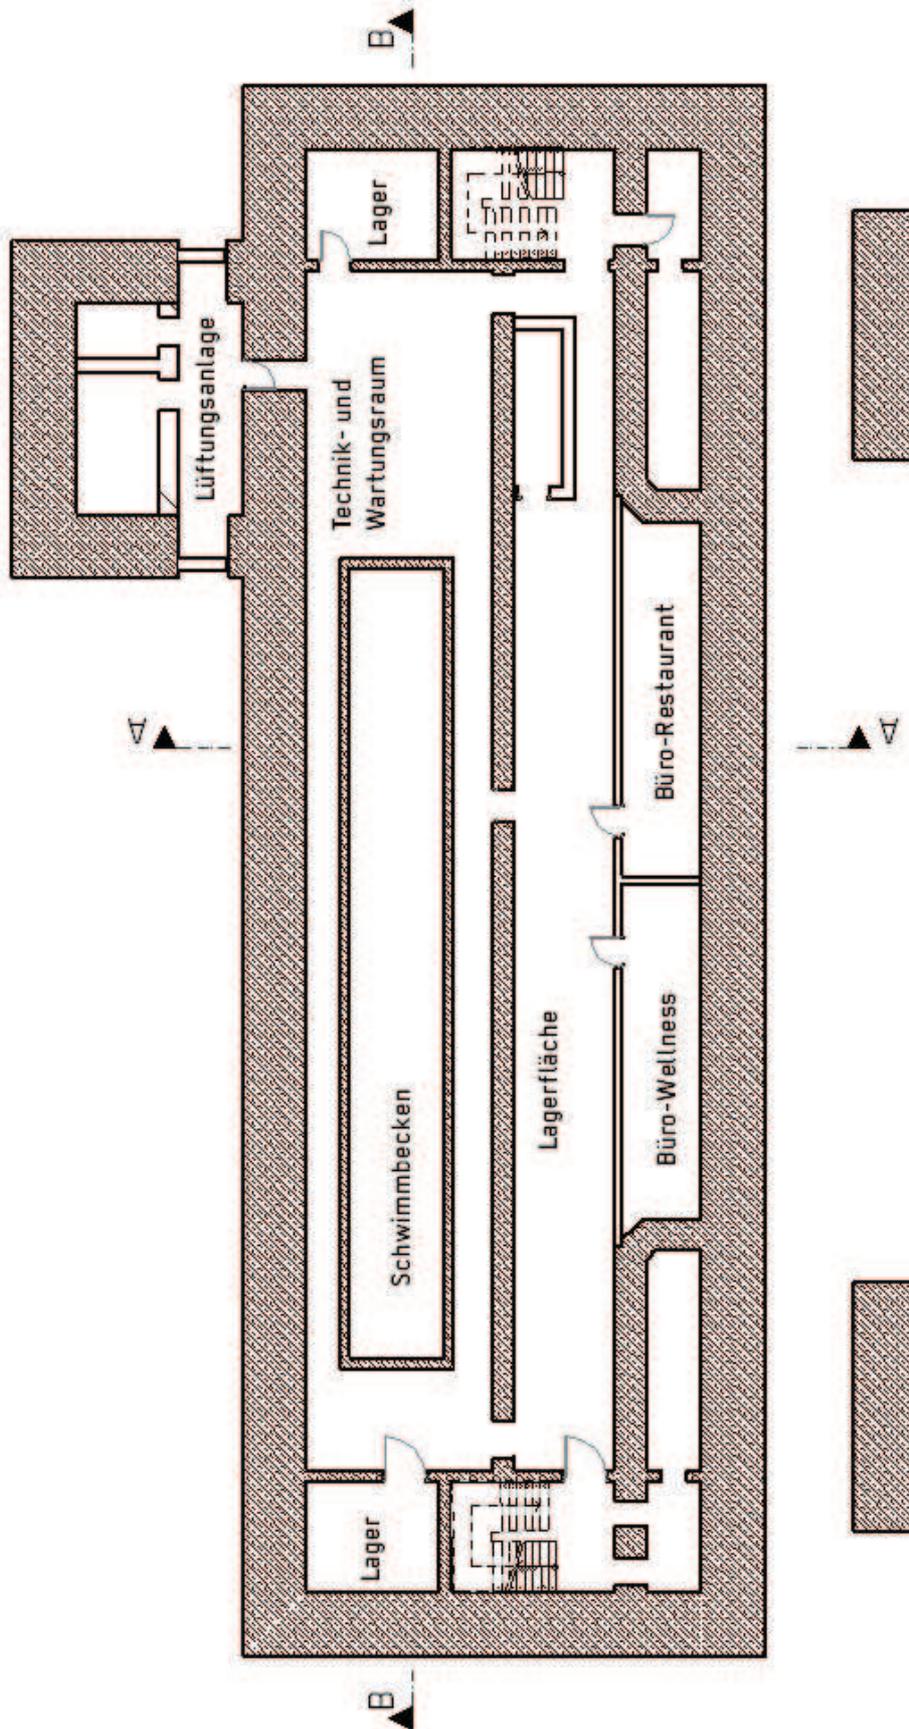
, Grundriss Kellergeschoss
